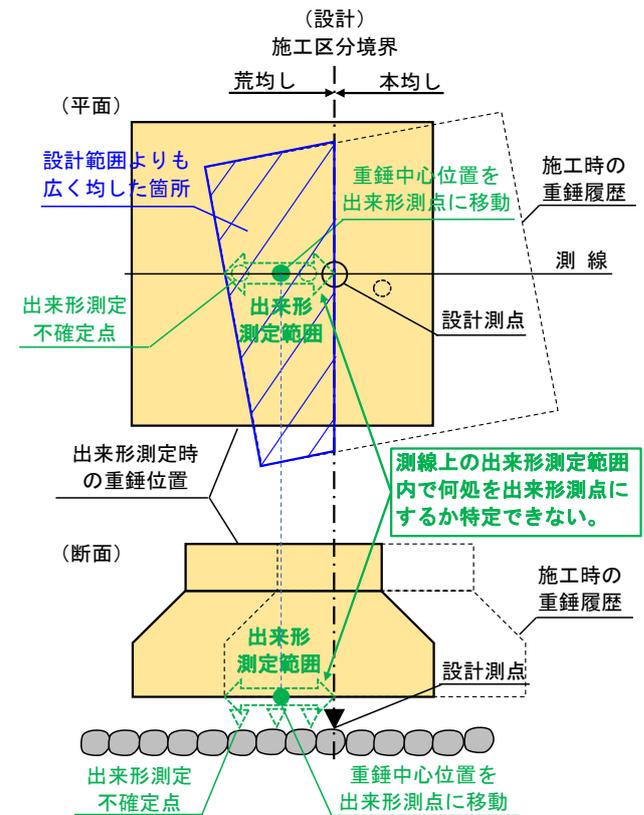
施工完了後の施工履歴データによる捨石本均しの距離計測
